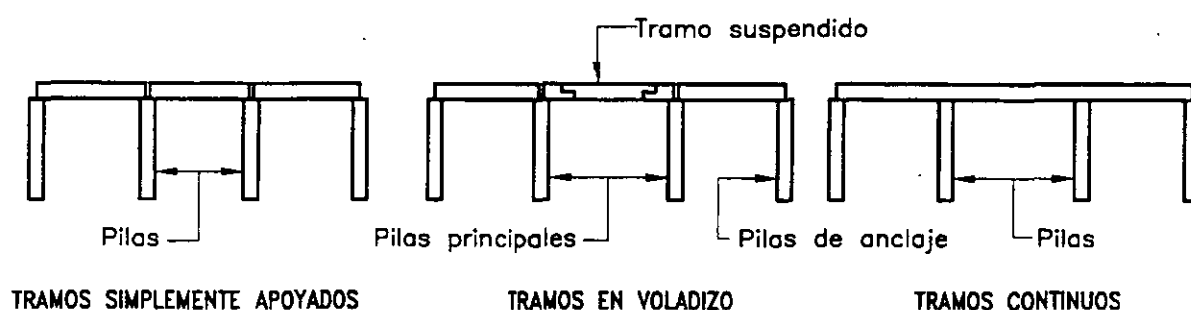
Disposición estructural de los miembros principales de carga de un puente.
